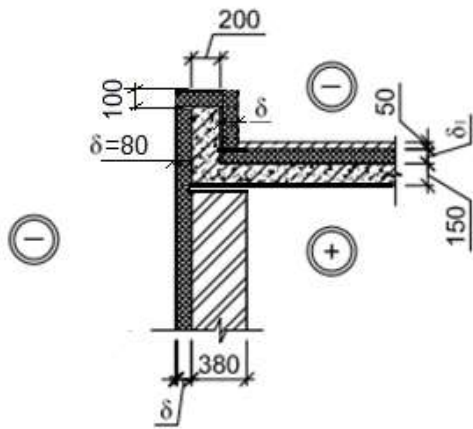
Усовершенствованная конструкция узла примыкания наружной стены к чердачному перекрытию.
